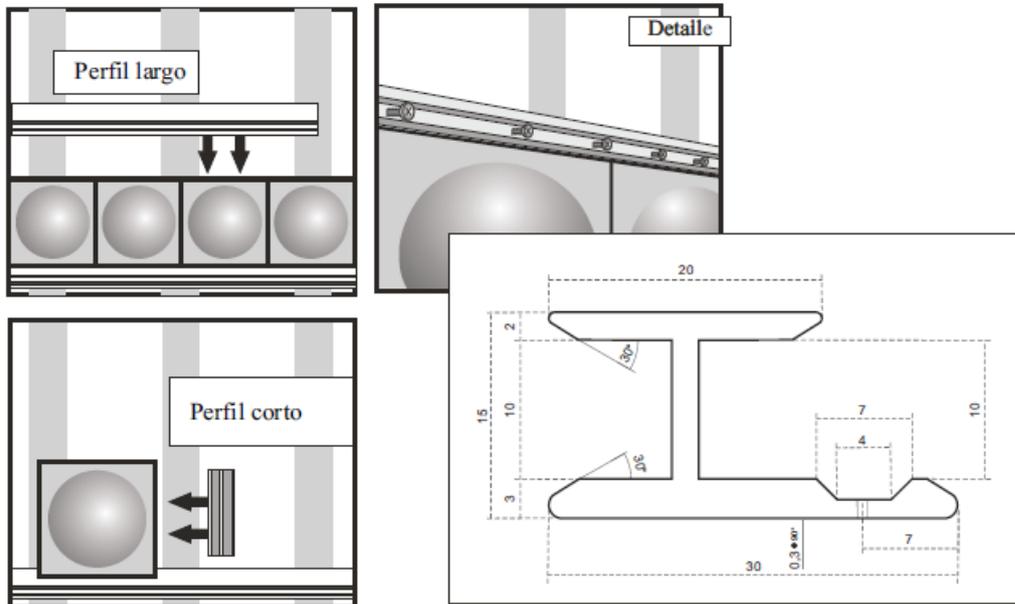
Installazione a secco su parete piana o su montanti in legno, mediante profili metallici di supporto
